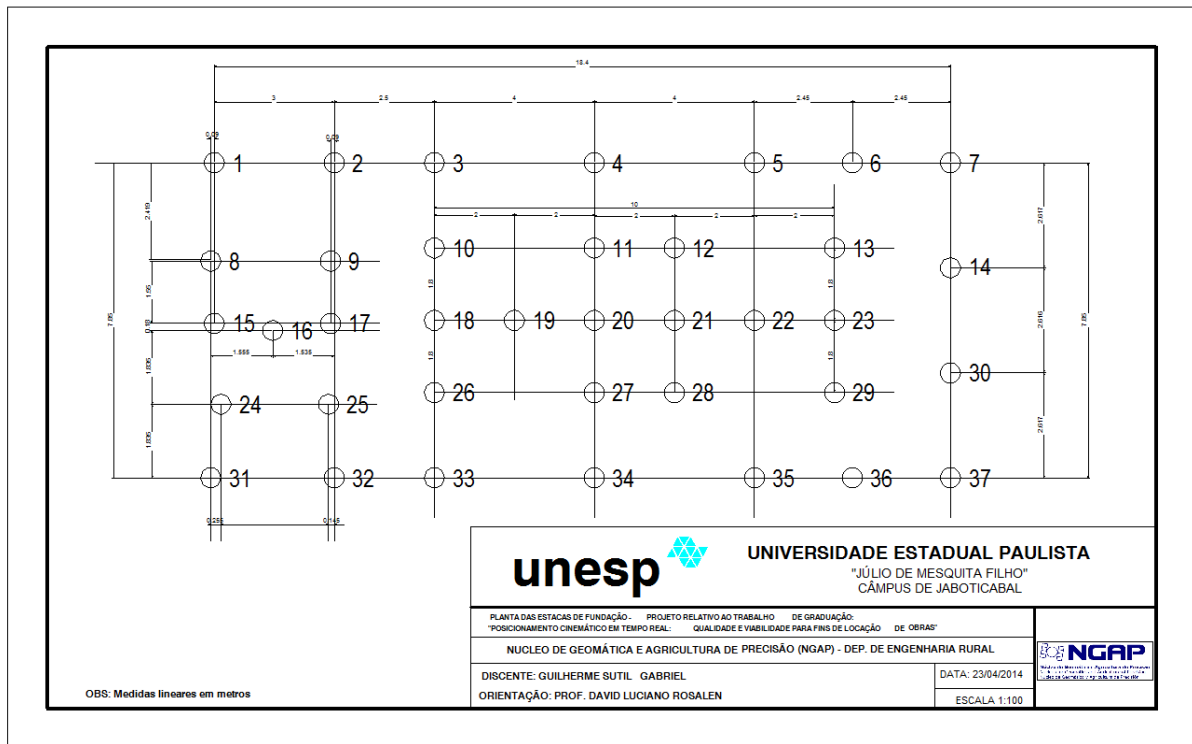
Planta do projeto de fundações utilizado no experimento.
